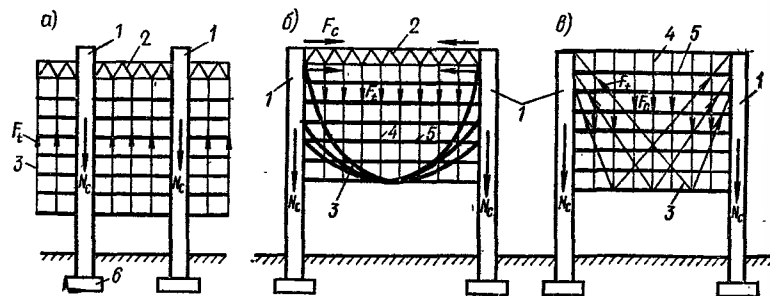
Конструктивные схемы двухствольных зданий с подвешенными этажами
